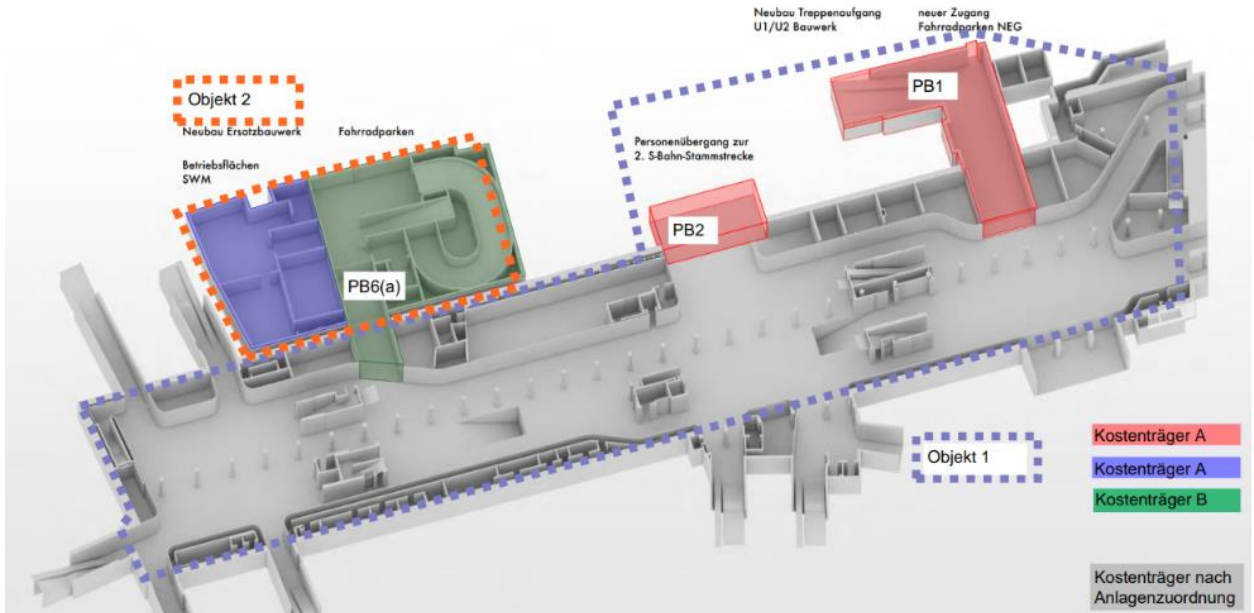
Einteilung Planungsbereiche – 1. Untergeschoss
